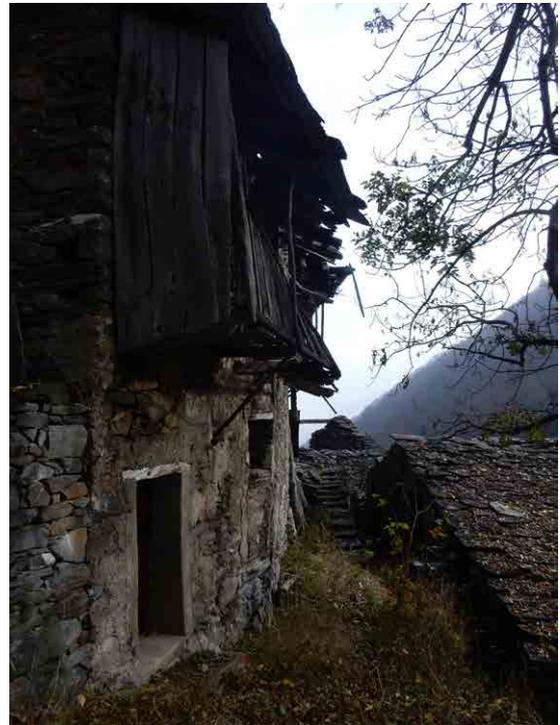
| Balcone con parapetto compatto laterale di protezione (2019)
